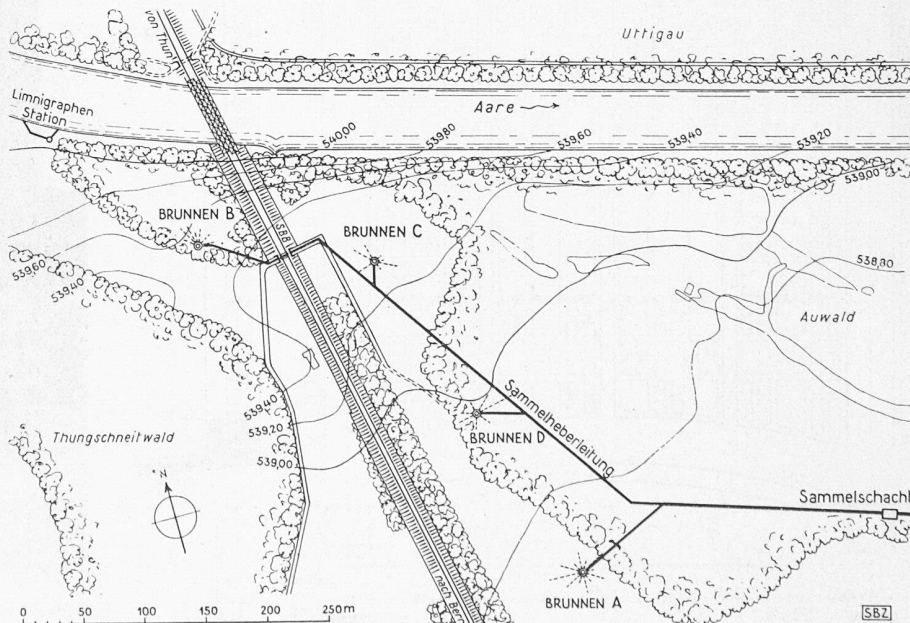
Lage der Brunnen im Fassungsgelände des Aaretal-Grundwasserwerks bei Kiesen. Kurven des Grundwasserstandes am 8. Mai 1947. Masstab 1:6000
